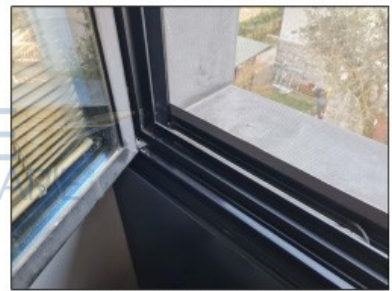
DETTAGLIO INFISSO IN ALLUMINIO
